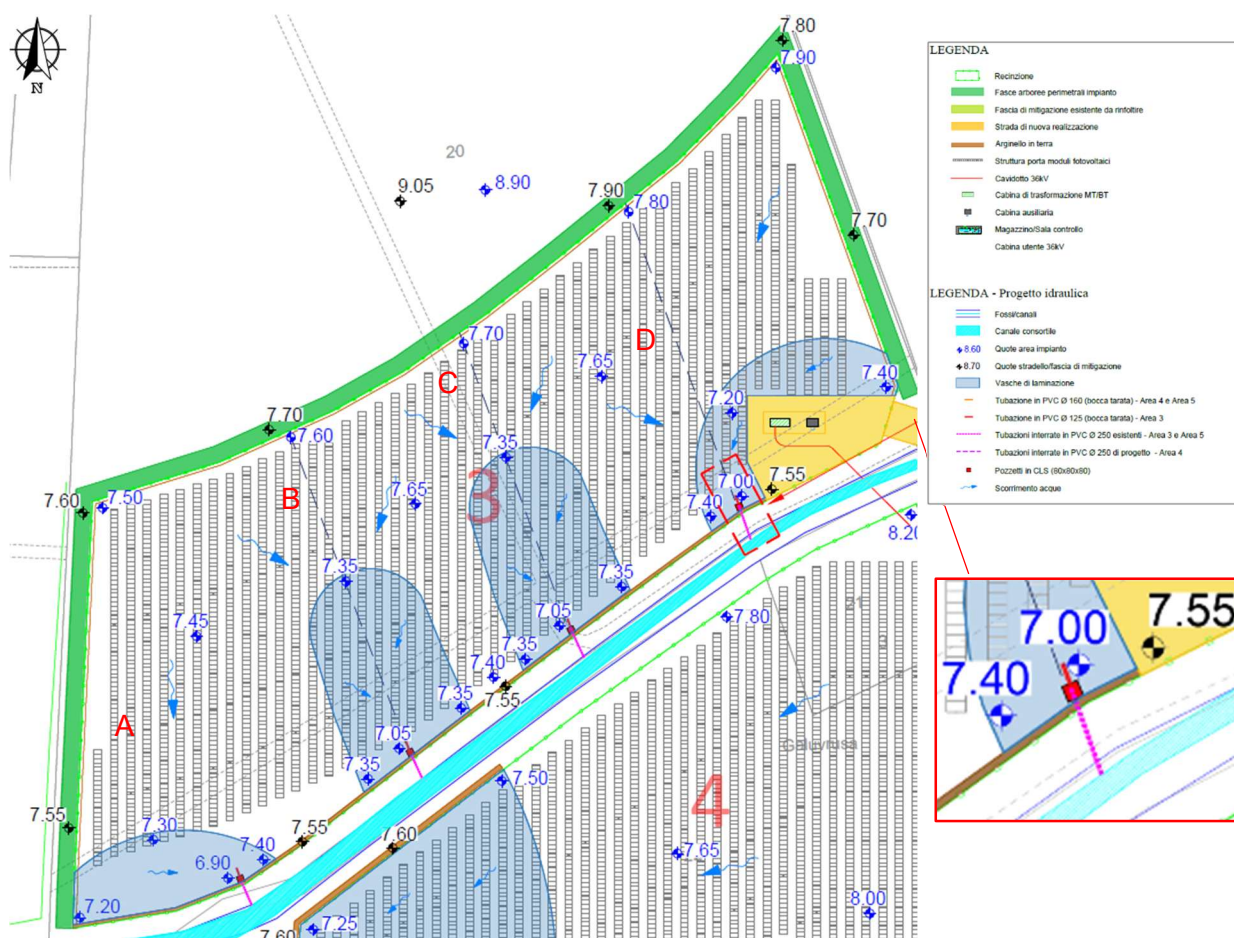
Individuazione vasche di laminazione area 3 (stralcio Tav. 43B)
